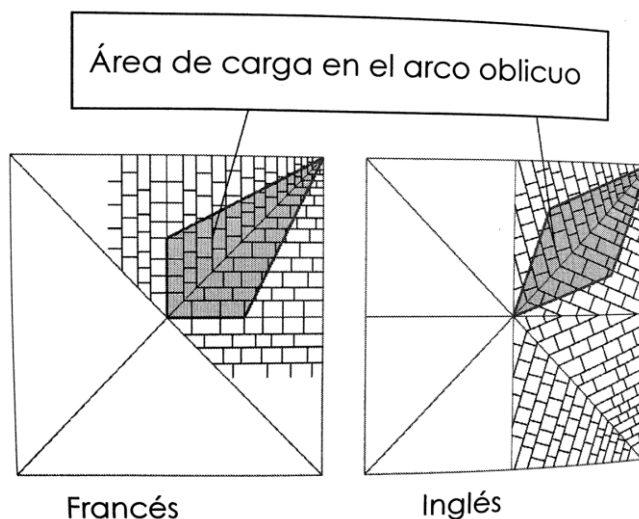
Planimetría de bóvedas de crucería góticas. (Mas-Guindal, 2011)
